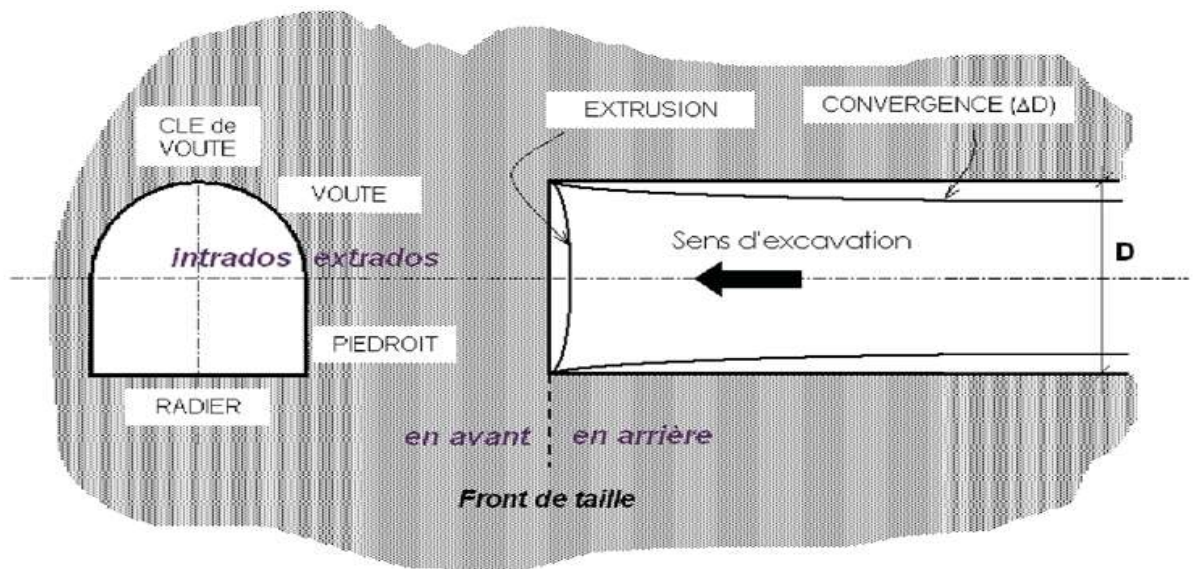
Coupe transversale et longitudinale d'un tunnel au voisinage du front de taille
